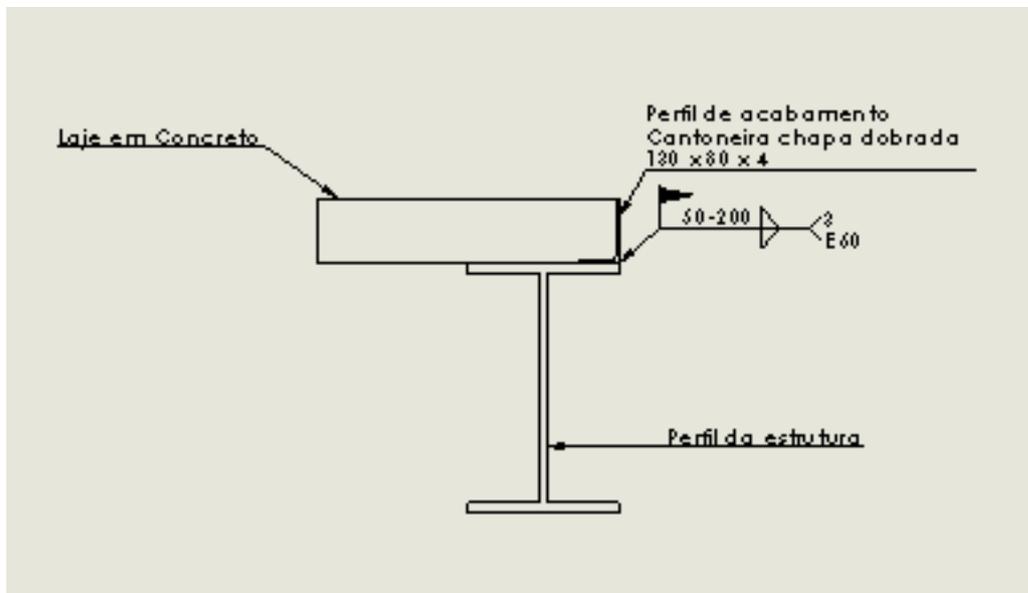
Detalhe do perfil de acabamento de topo de laje. Sem escala.
